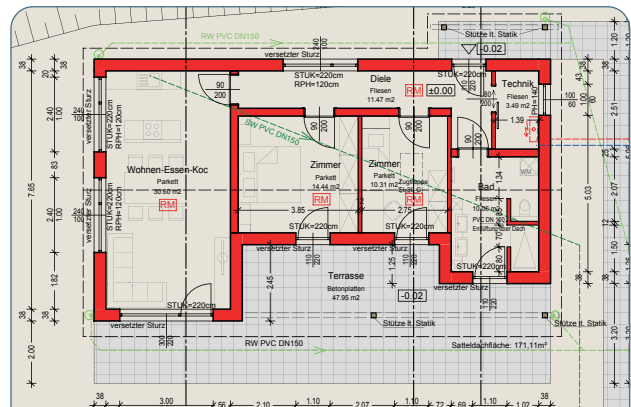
Beispiel Grundrissplan Erdgeschoss
